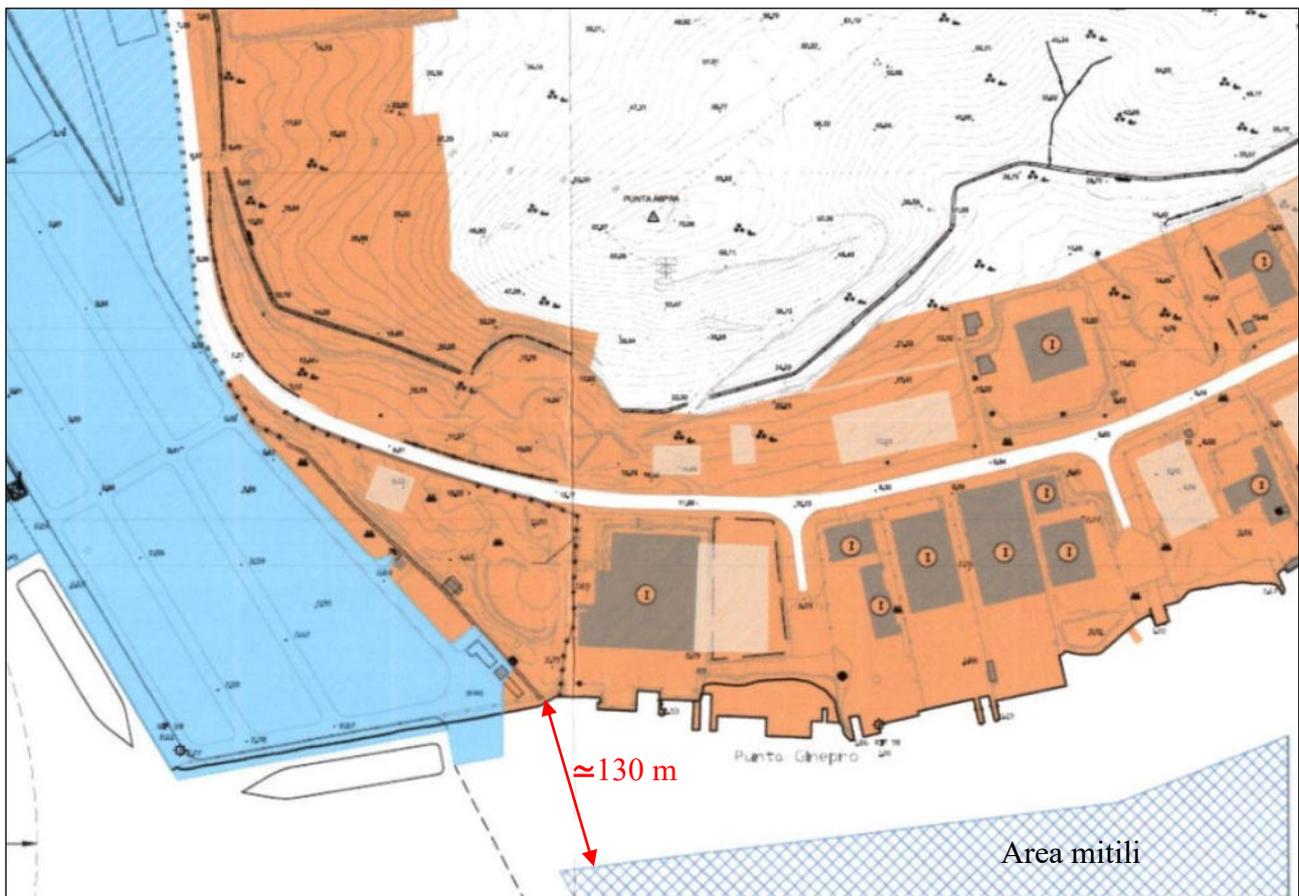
Planimetria con indicazione aree miticoltura PRP
